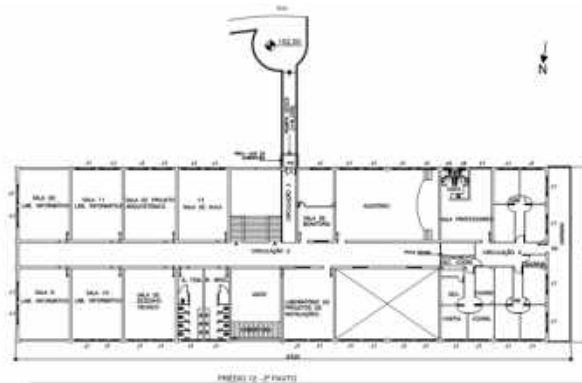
Planta baixa 2º pavimento Prédio 12
